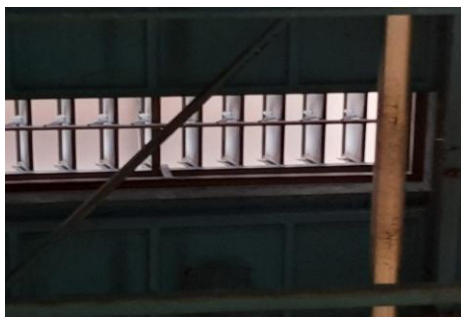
opendakconstructie doorloopovens, van binnen uit gezien
